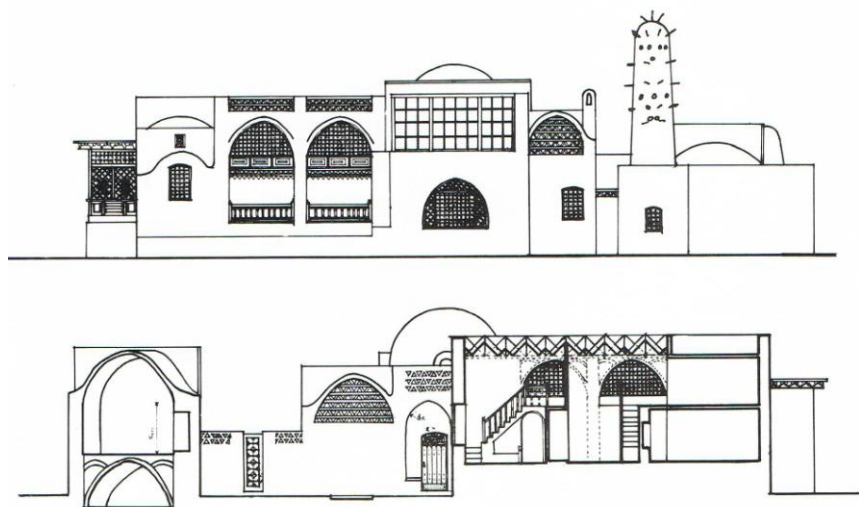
Alzado principal y Sección de las áreas nocturnas
